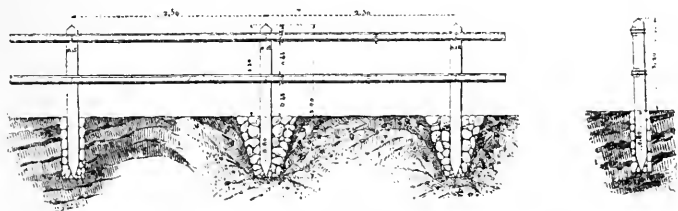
Barrière en Bois. — Élévation dégagée des Terres. Fig. 71. — Coupe.
